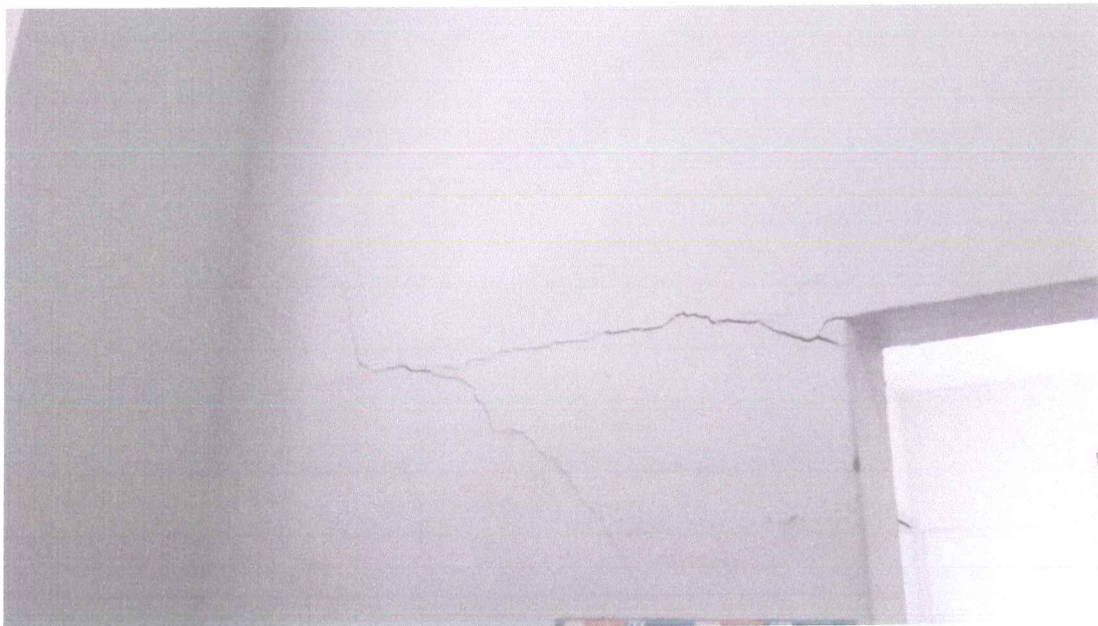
PAREDE DA UNIDADE APRESENTANDO TRINCAS E FISSURAS
